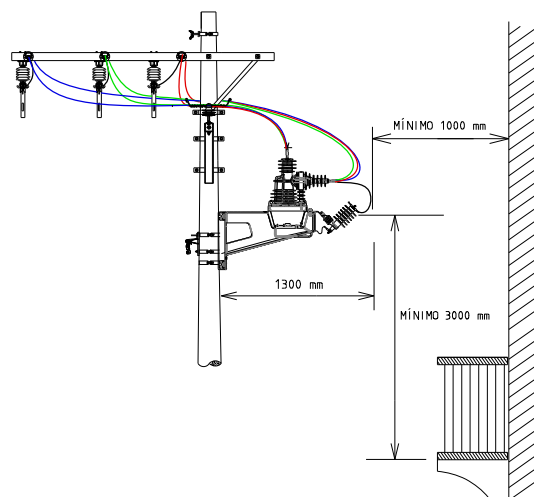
Afastamento horizontal e vertical entre ponto energizado e sacada ou janela de edificação
